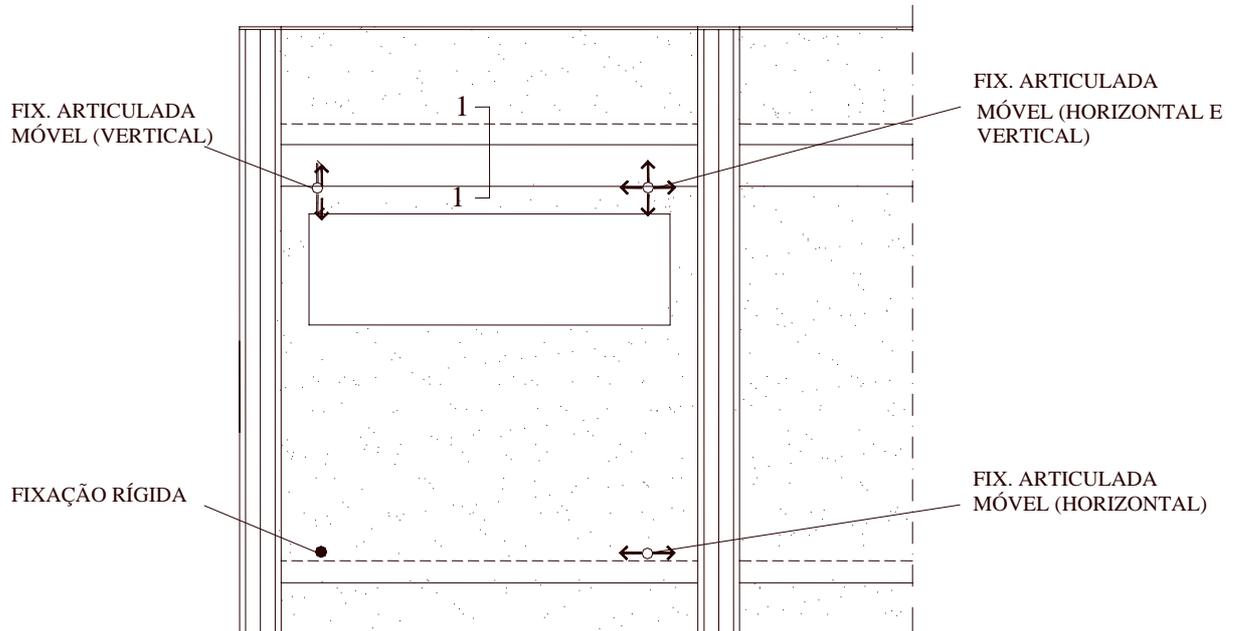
Elevação externa típica para um painel de vedação em concreto, com fixação na laje e na viga.
